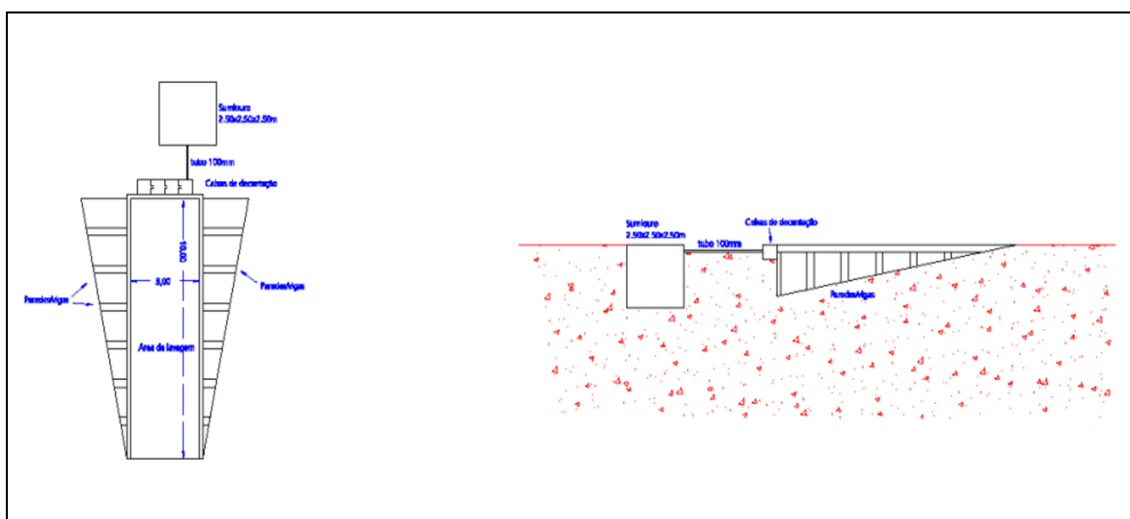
Sistema de separação de resíduos na lavagem do caminhão betoneira.
